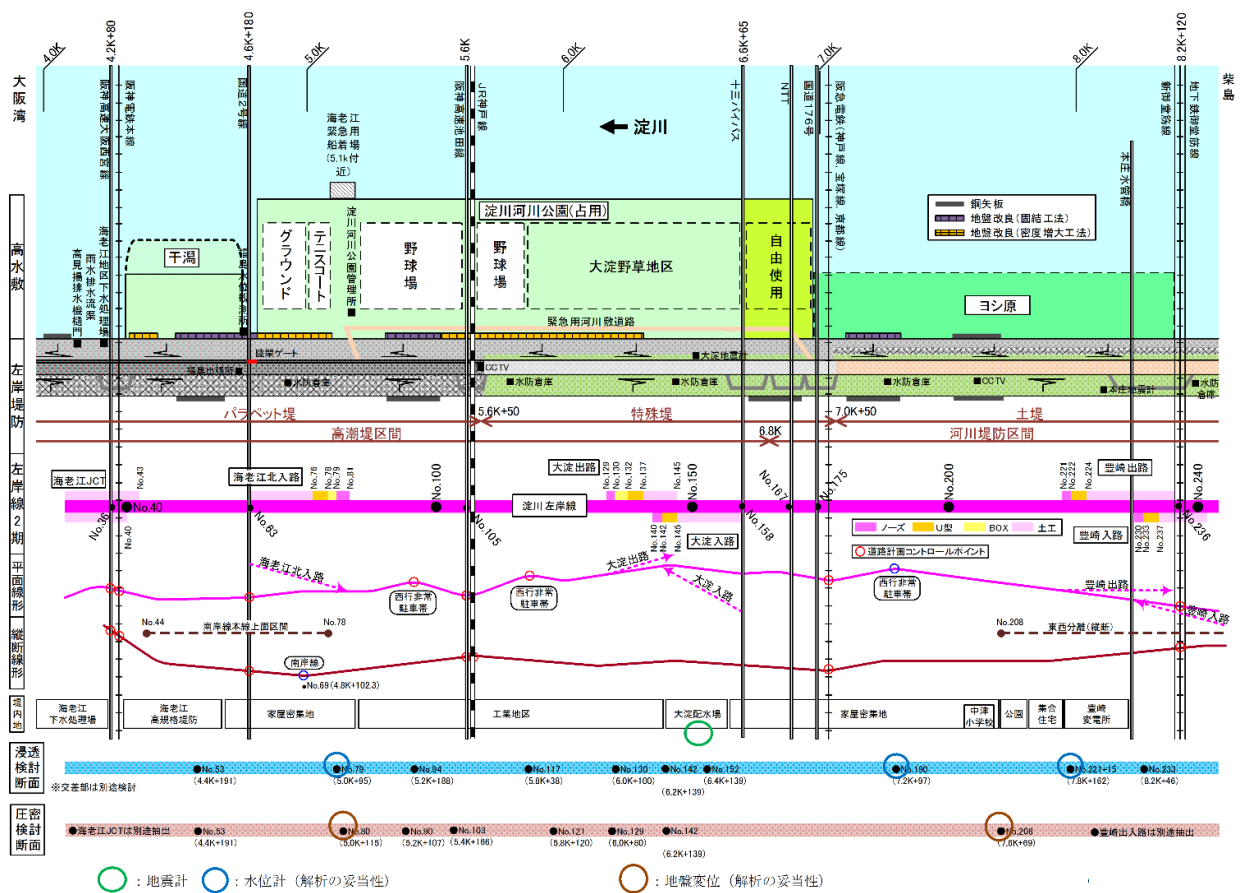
道路ボックス内地震計の設置例（平面図）
